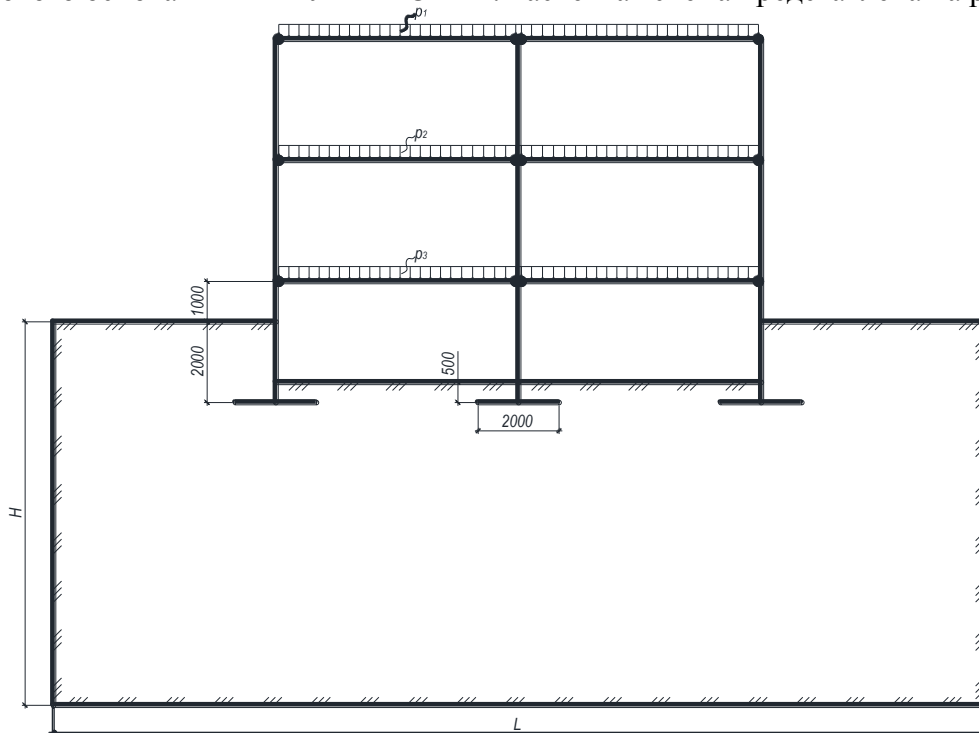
Схема к расчету каркаса на сейсмическое воздействие с учетом грунтового основания
